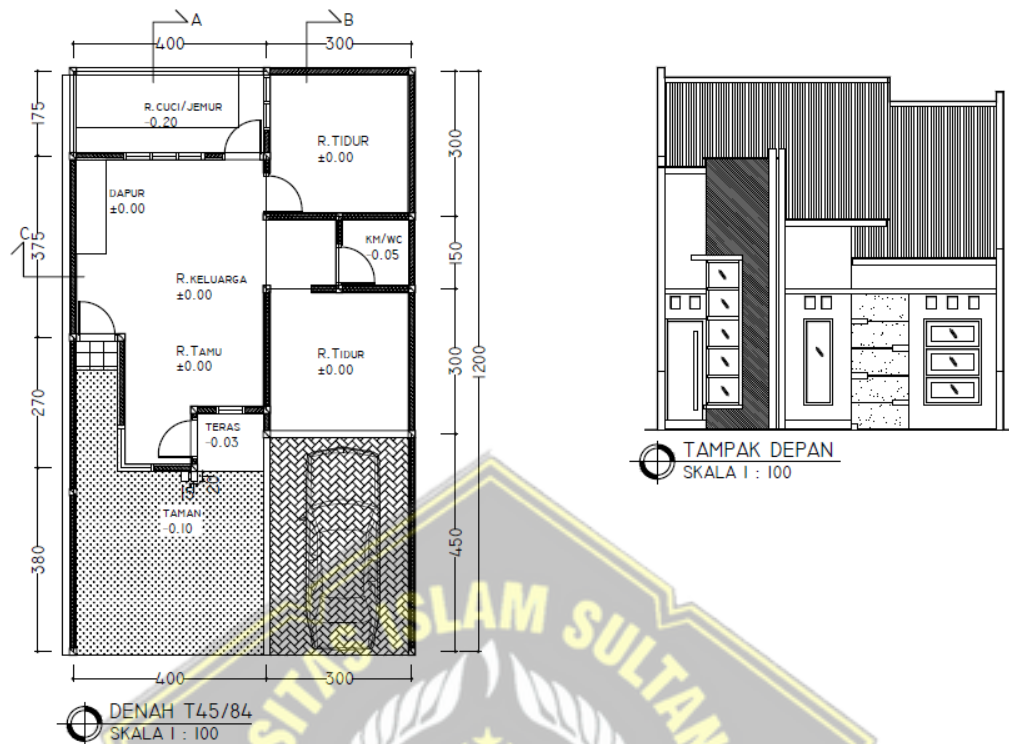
merupakan denah letak ruangan dan tampak depan dari bangunan rumah tipe 36 dengan luas bangunan 36 m² dan luas tanah 84 m².
